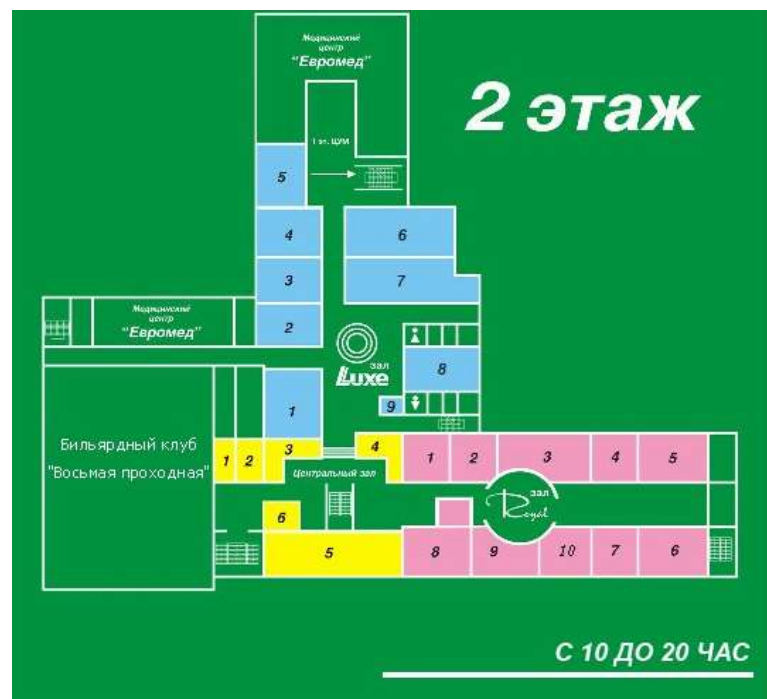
План второго этажа БЦ «Green House»
